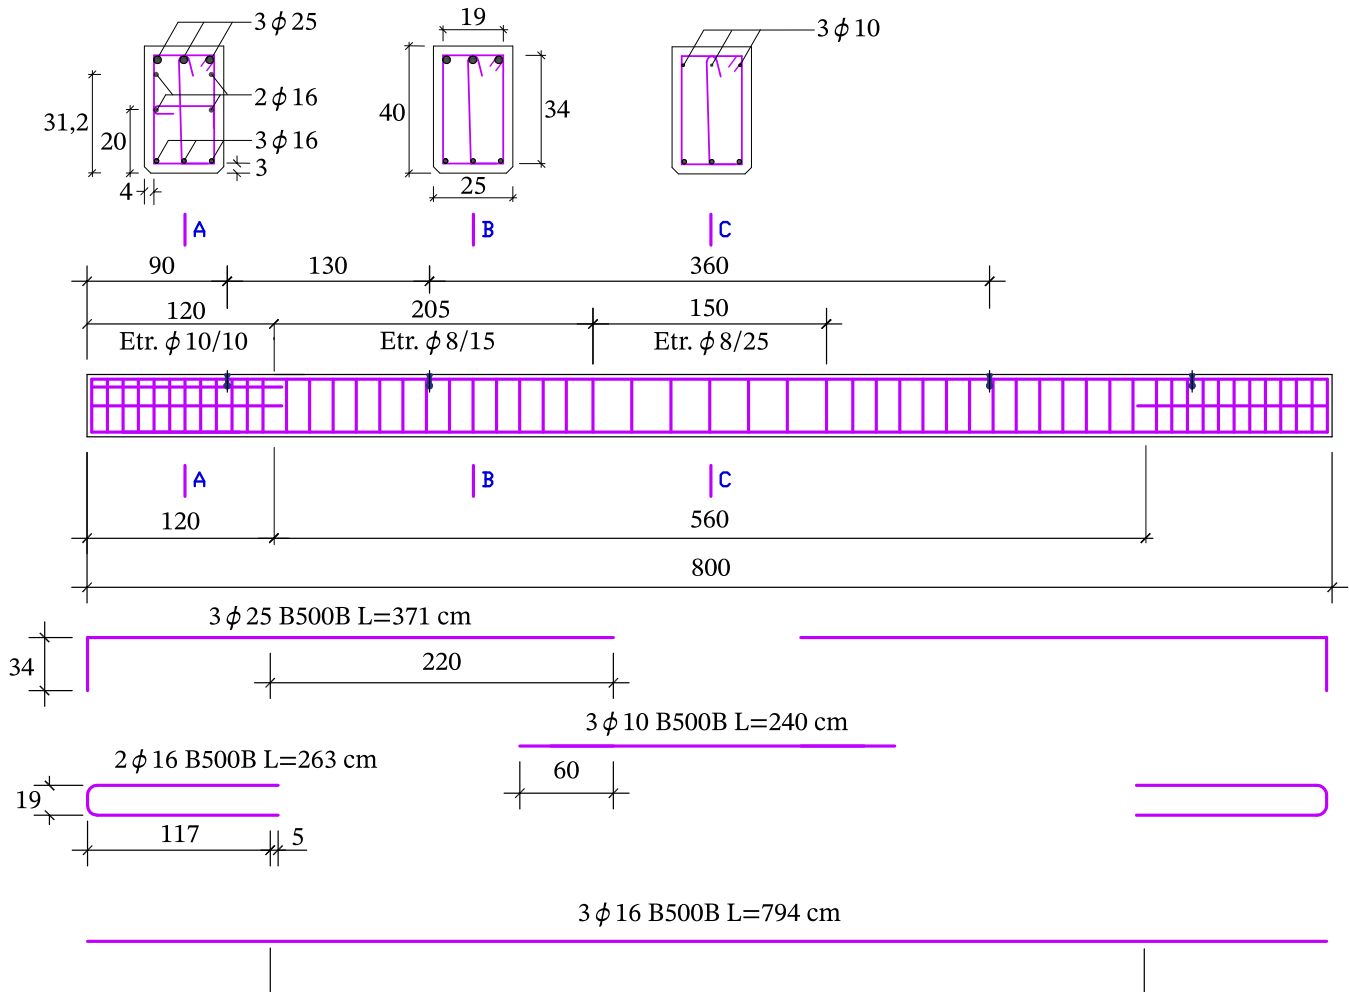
Plans de coffrage et de ferrailage de la poutre.
